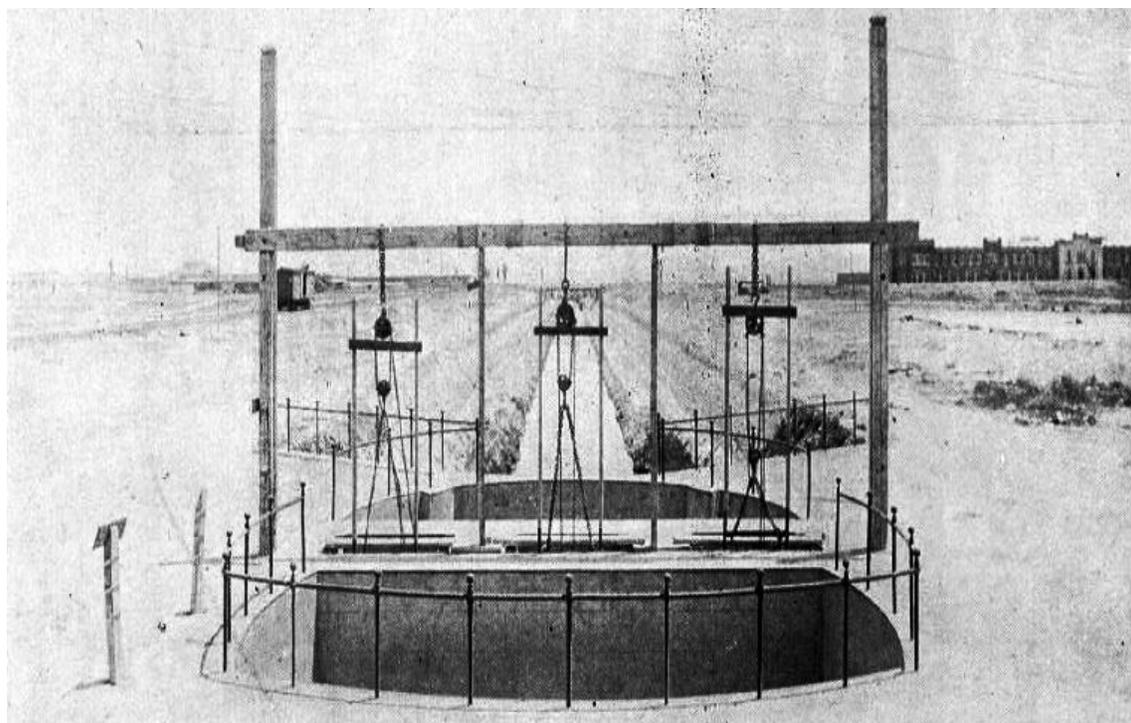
Avancement de la construction des collecteurs du système des égouts.
